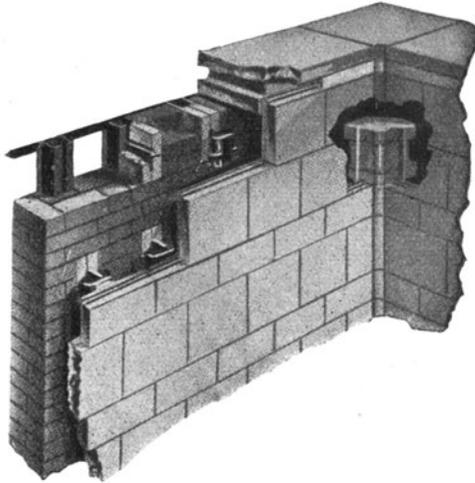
Luftgekühlte Wand der Drake Non-Clinkering Furnace Company für Dampfkessel.
